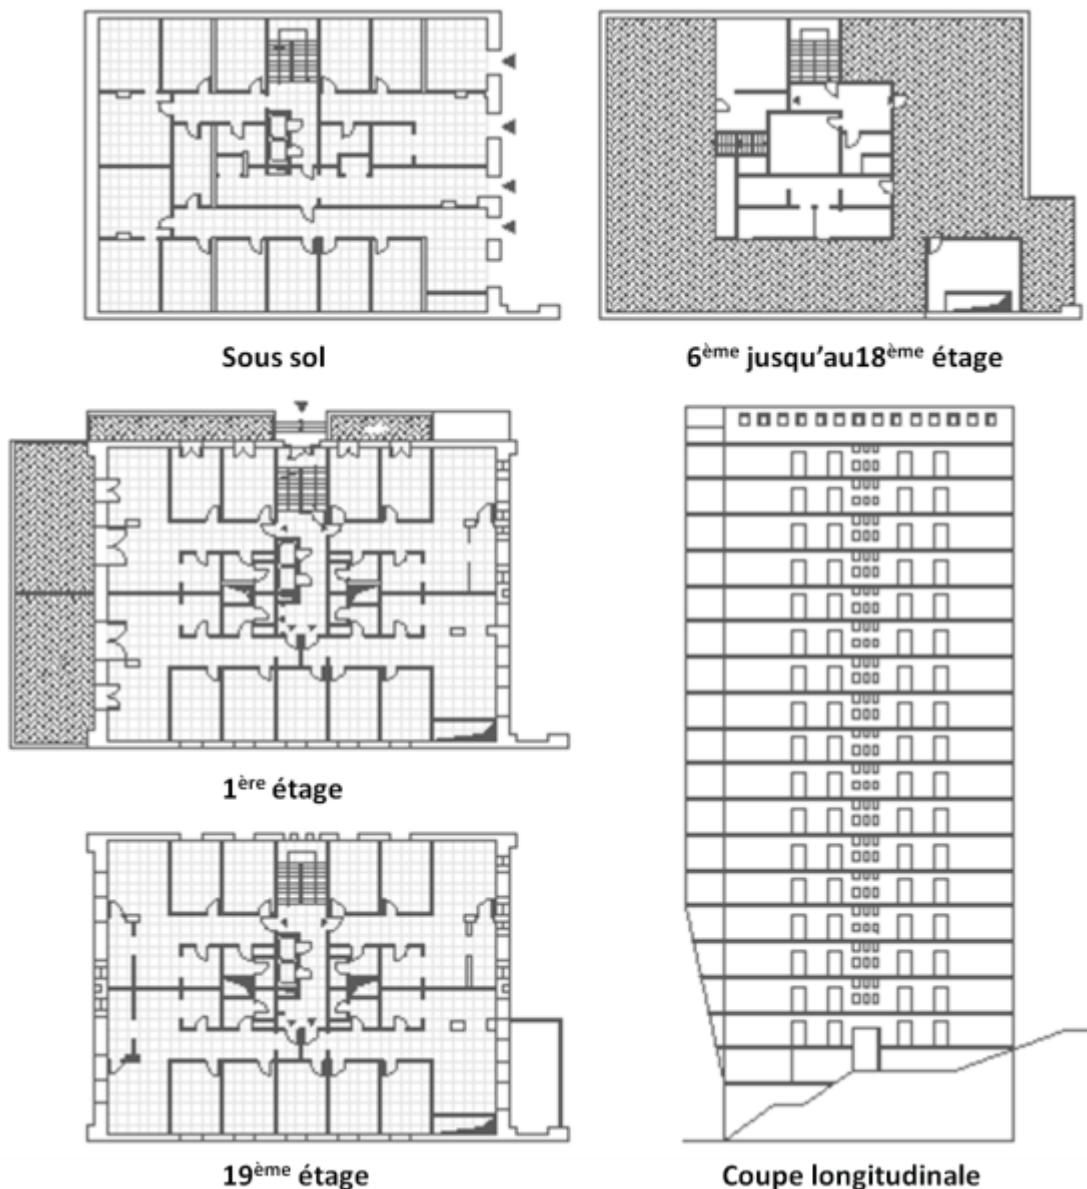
6: Vues en plan et coupe verticale de la tour.
